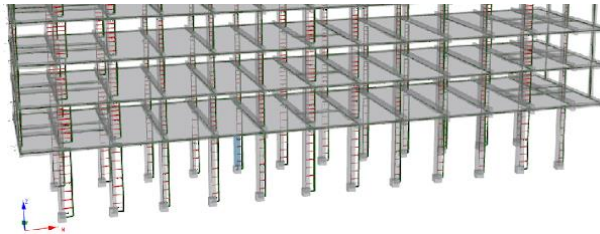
Equilíbrio de esforço transverso na direção longitudinal para um carregamento horizontal aplicado à estrutura, sem as vigas V9, no Seismostruct.
